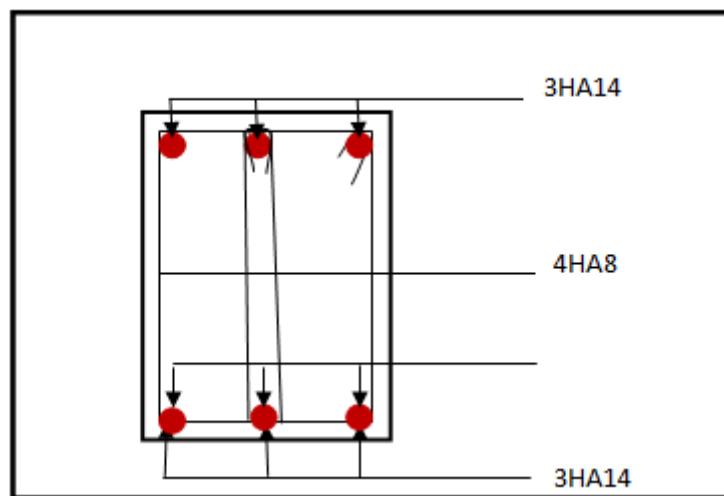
Ferrailage aux appuis d'une poutre principale.
